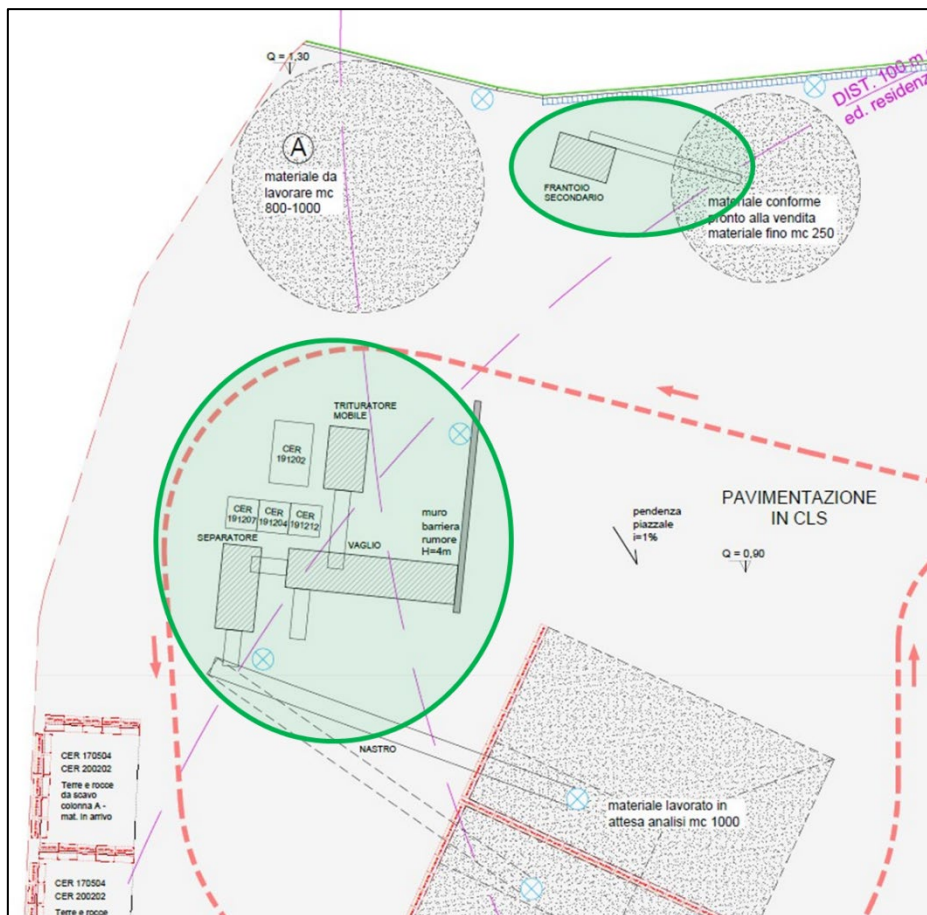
Estratto Allegato 2.2 allo SPA - Layout impianto – Identificazione delle sorgenti
